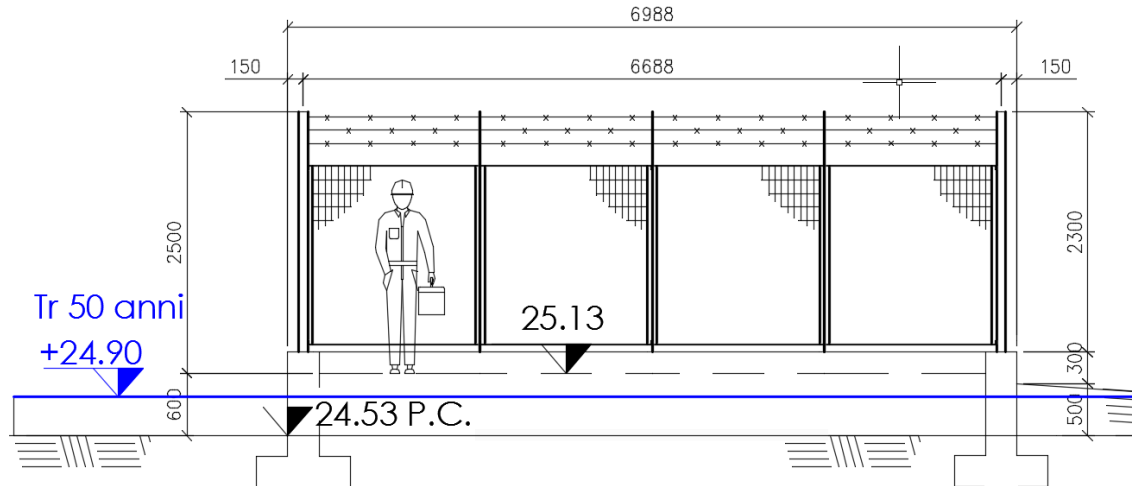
Sezione schematica dell'opera in progetto e delle quote significative
